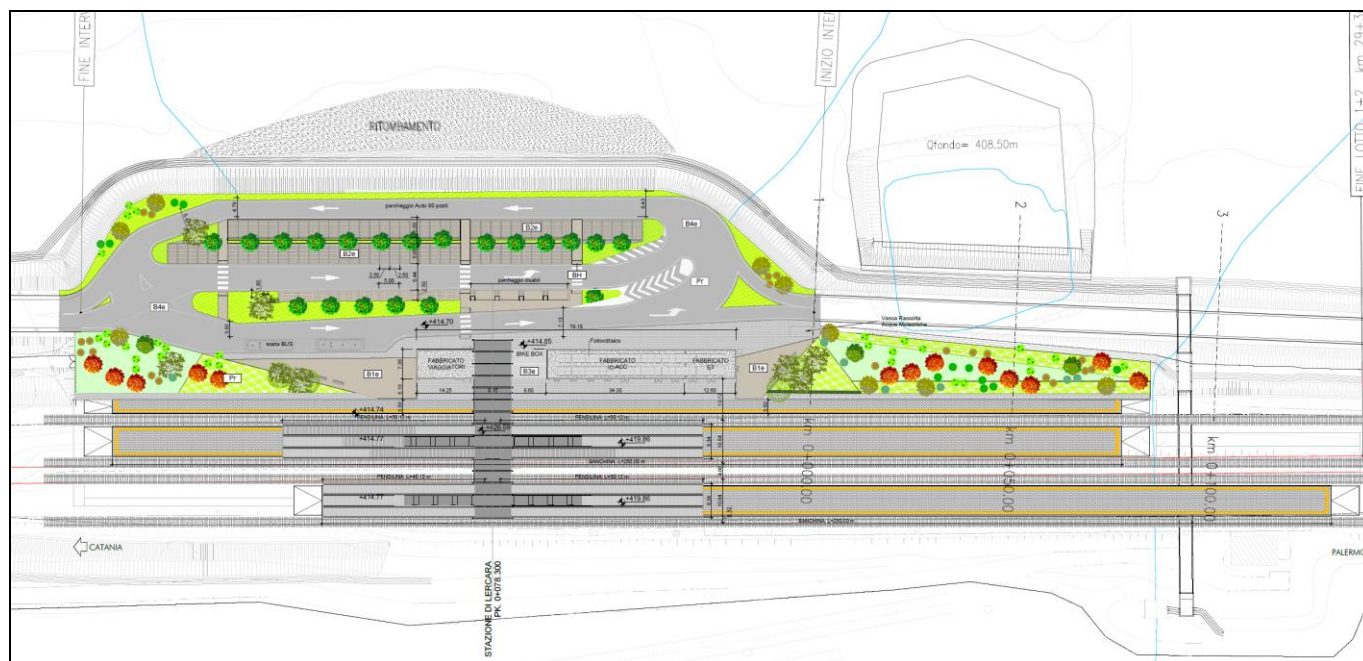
Stazione di Lercara Diramazione: assetto planimetrico
